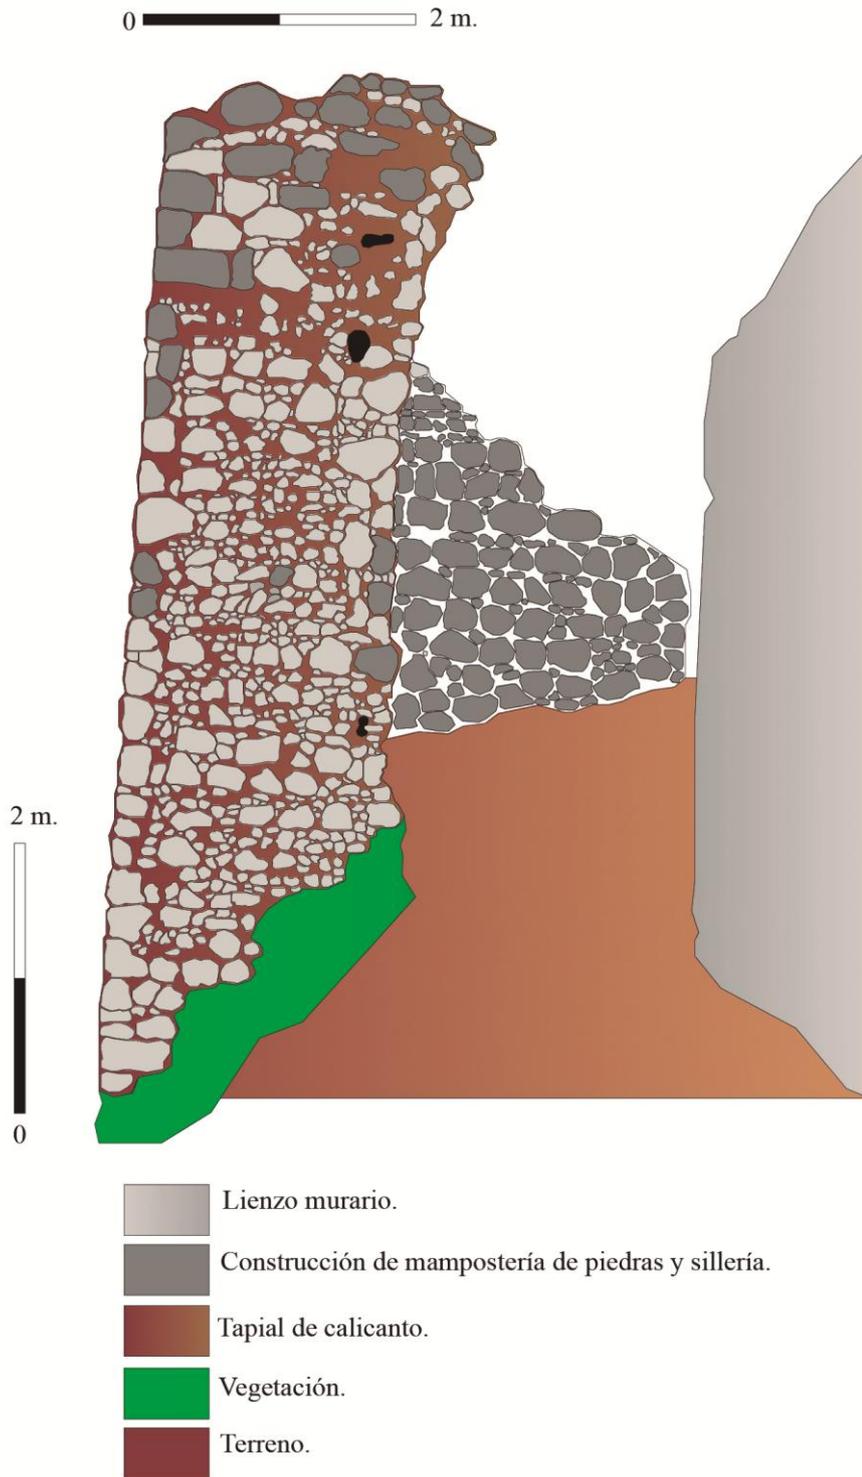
Entrada de la Puerta de la Ciudad en su cara exterior sureste la técnica constructiva, mampostería enripiada verdugada con ladrillo y piedras y refuerzo de sillares en las esquinas. (Elaboración propia).
